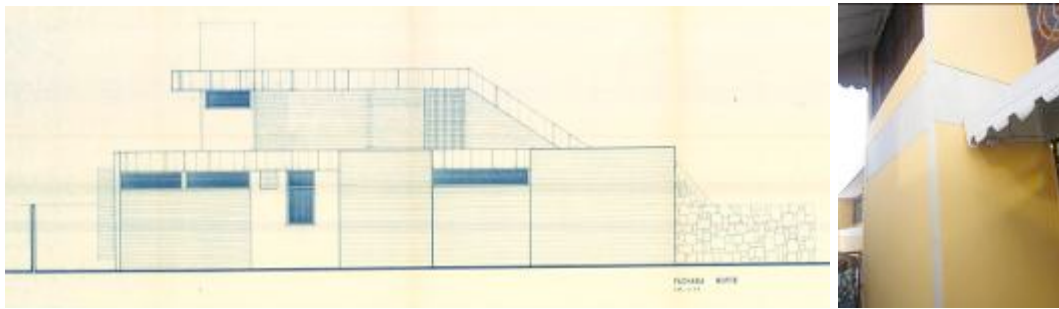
Demarcação de vigas e pilares em concreto aparente em duas residências.
